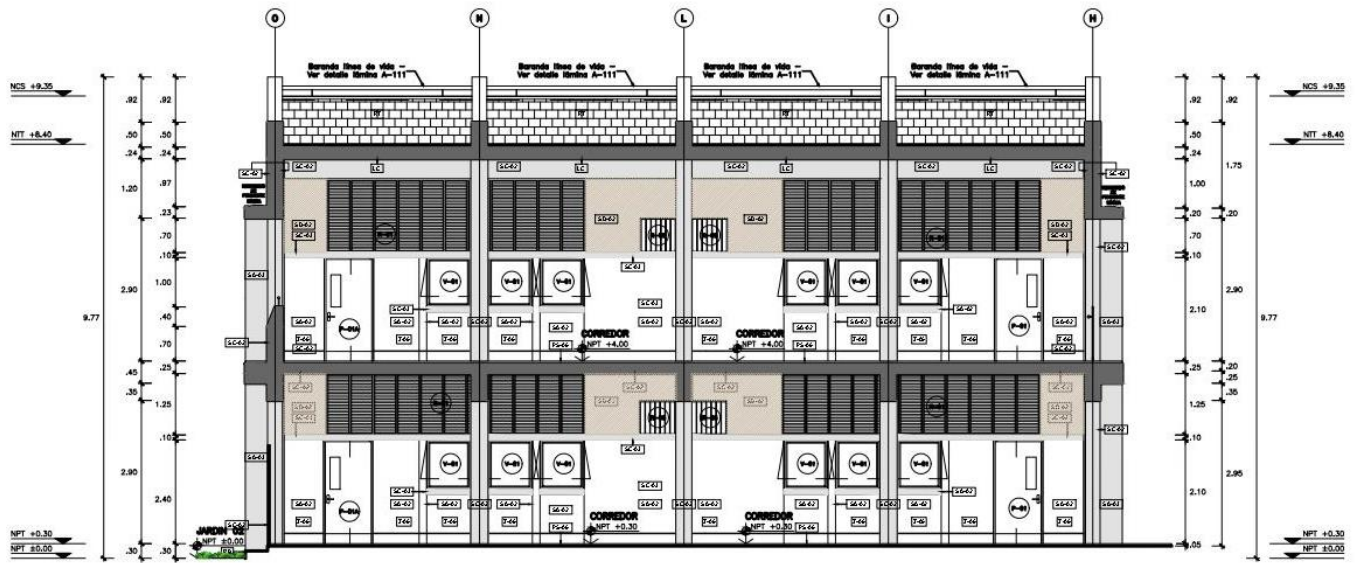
Modulo 1 y 2, corte arquitectónico E-E
